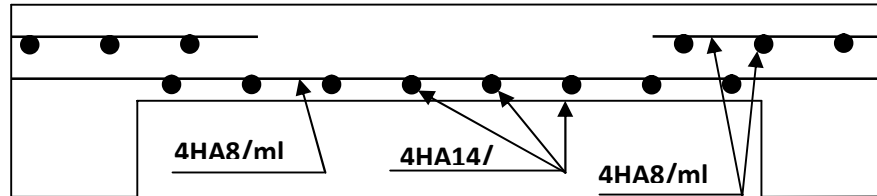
Schéma de ferrailage du deuxième type de balcon.
